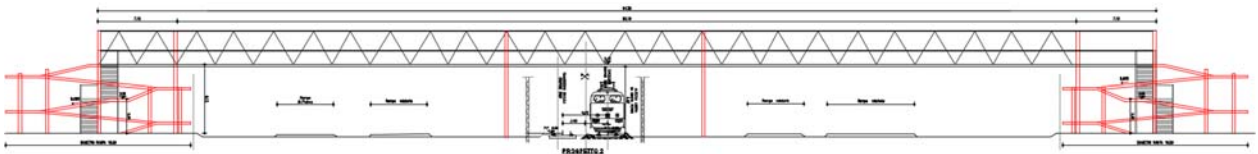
Passerella ciclopedonale Via Venezia -San Lazzaro_Prospetto
